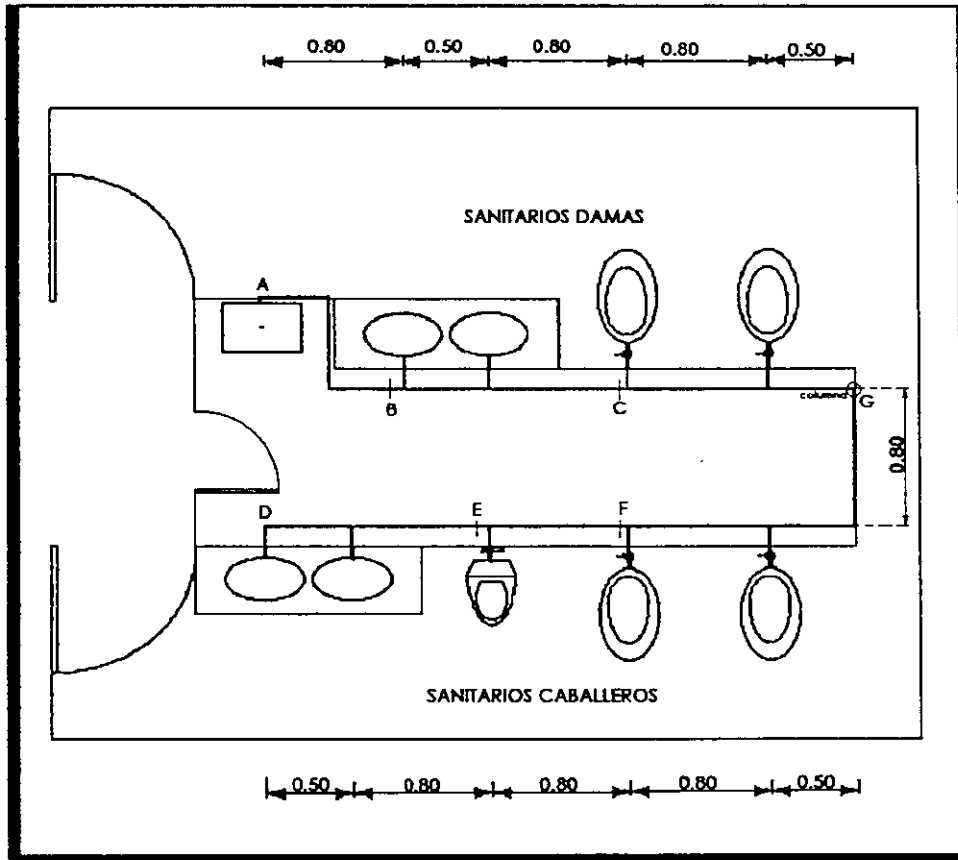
Planta arquitectónica de los sanitarios de un edificio.
